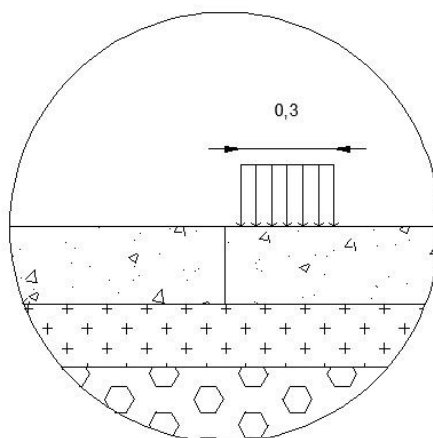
Pormenor do carregamento do pavimento na modelação numérica (cotas em metros)
